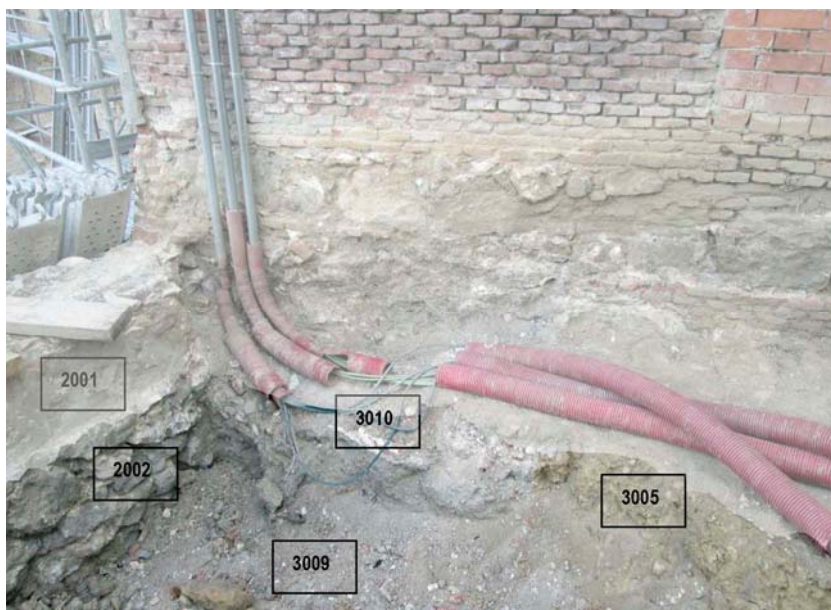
Detalle de la excavación en la zona de la torre T3.
